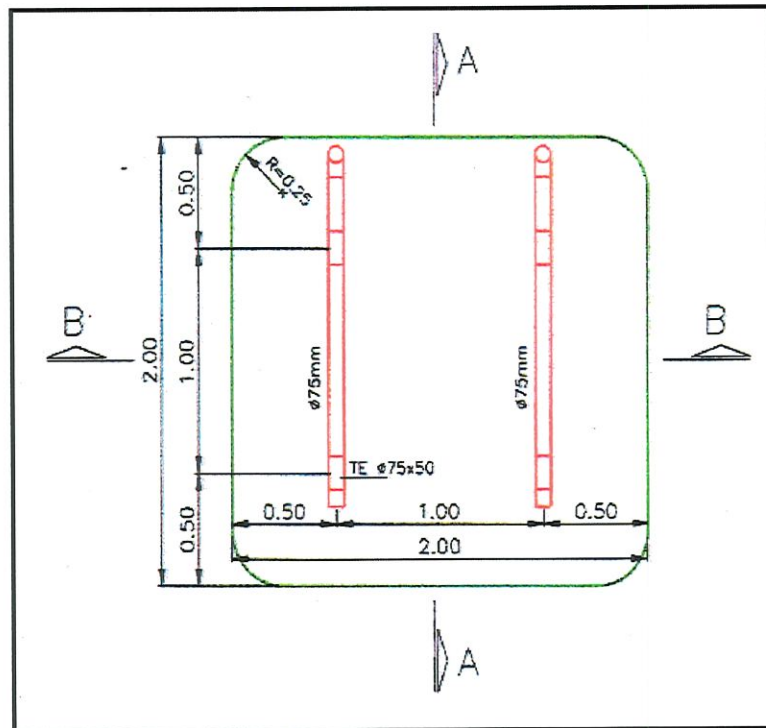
Planta baixa do reator UASB (cotas em metros) (OLIVA, 1997).
